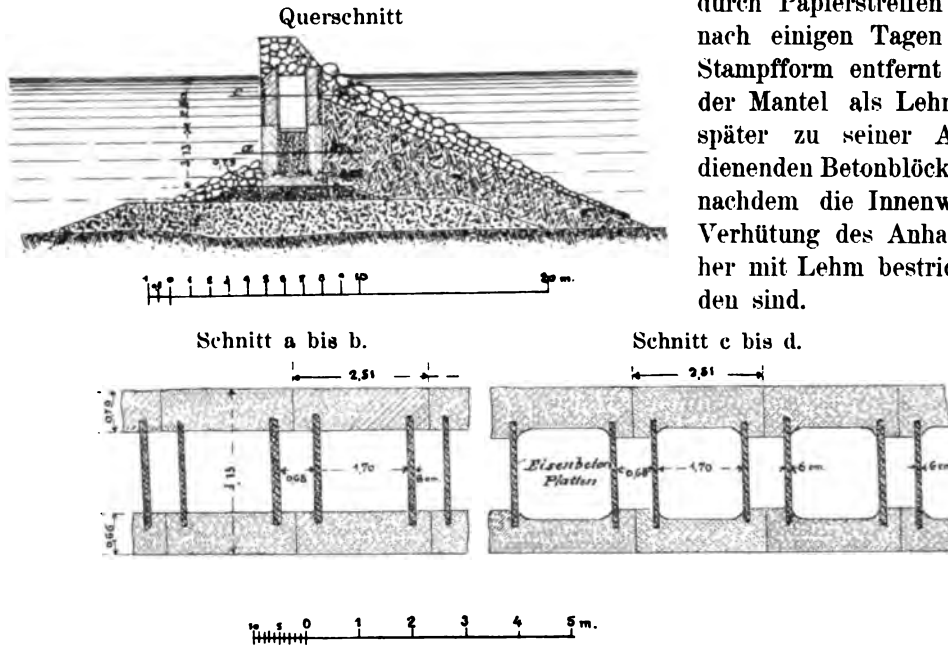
Querschnitt des Hafendamms in Kopenhagen und Grundriß der Blöcke.
